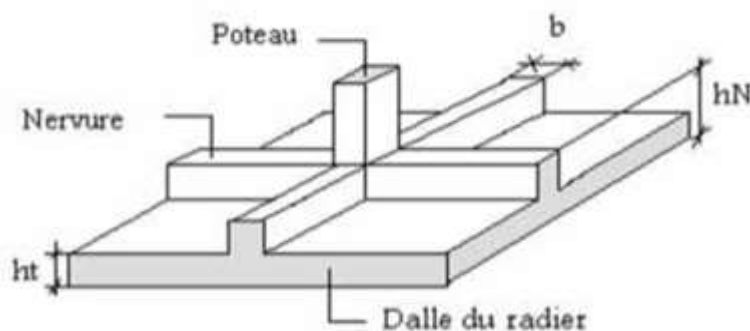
Disposition des nervures par rapport au radier et aux poteaux.
